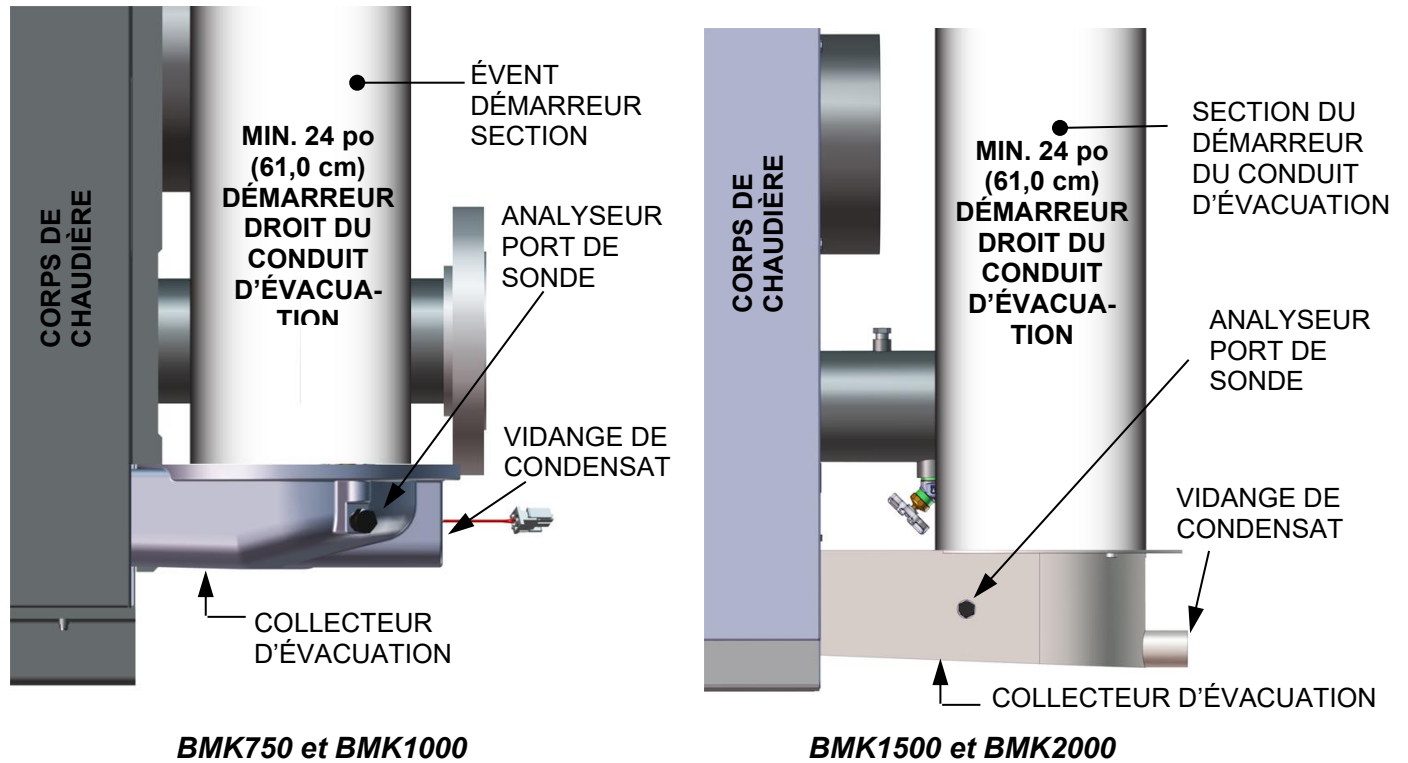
section du démarreur du conduit d'évacuation : vue latérale gauche
